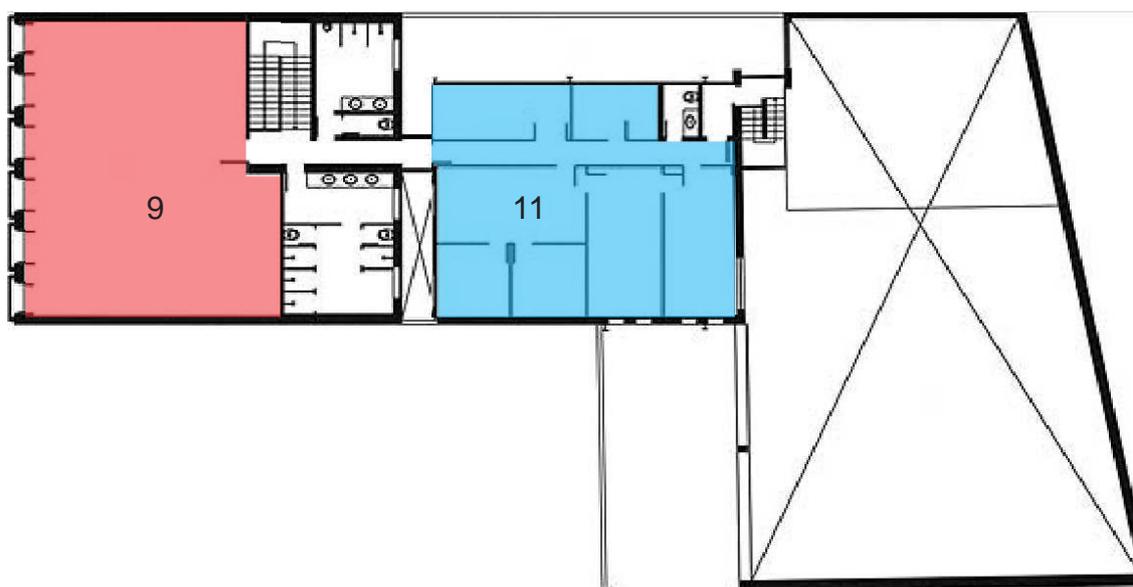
PLANTA SEGUNDO PAVIMENTO – SEM ESCALA
